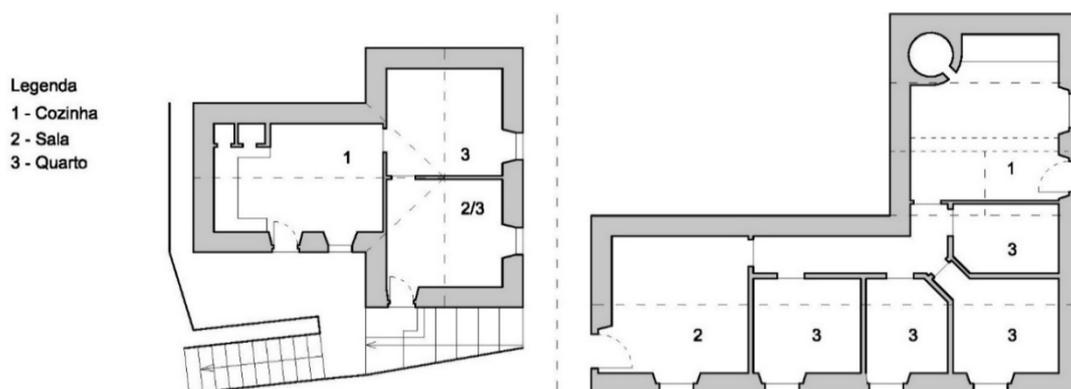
Plantas de moradia tipo linear (Dir. planta tipo; Esq. planta de evolução para o L)
